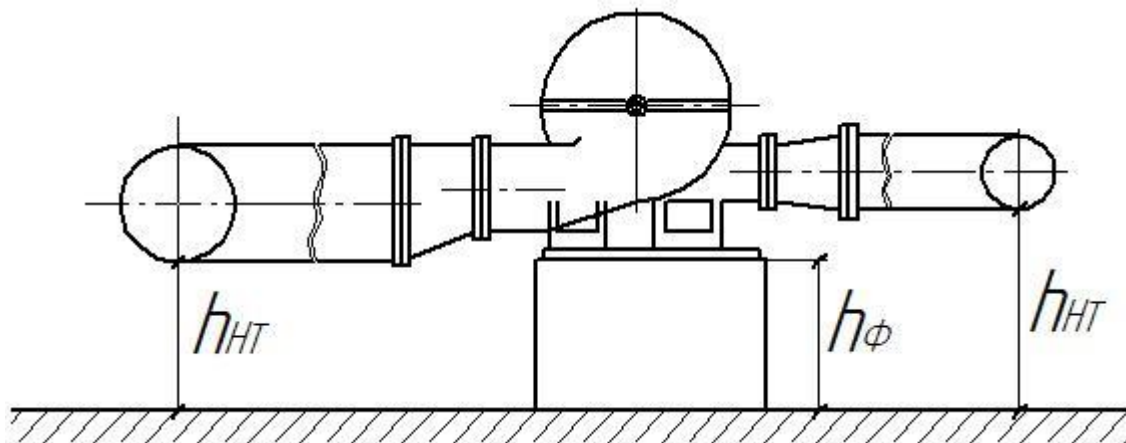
Схема розташування насосу до визначення позначки фундаменту
